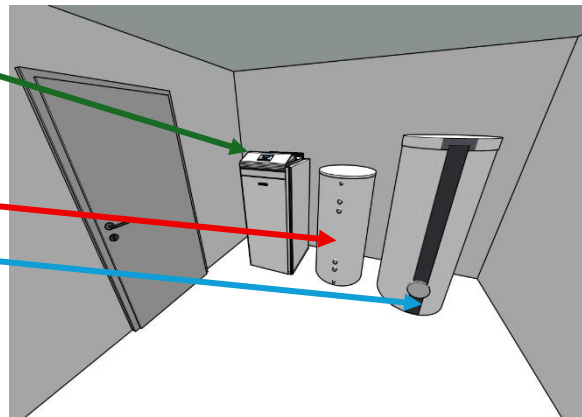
Heizraum mit Sole/Wasser Wärmepumpe
